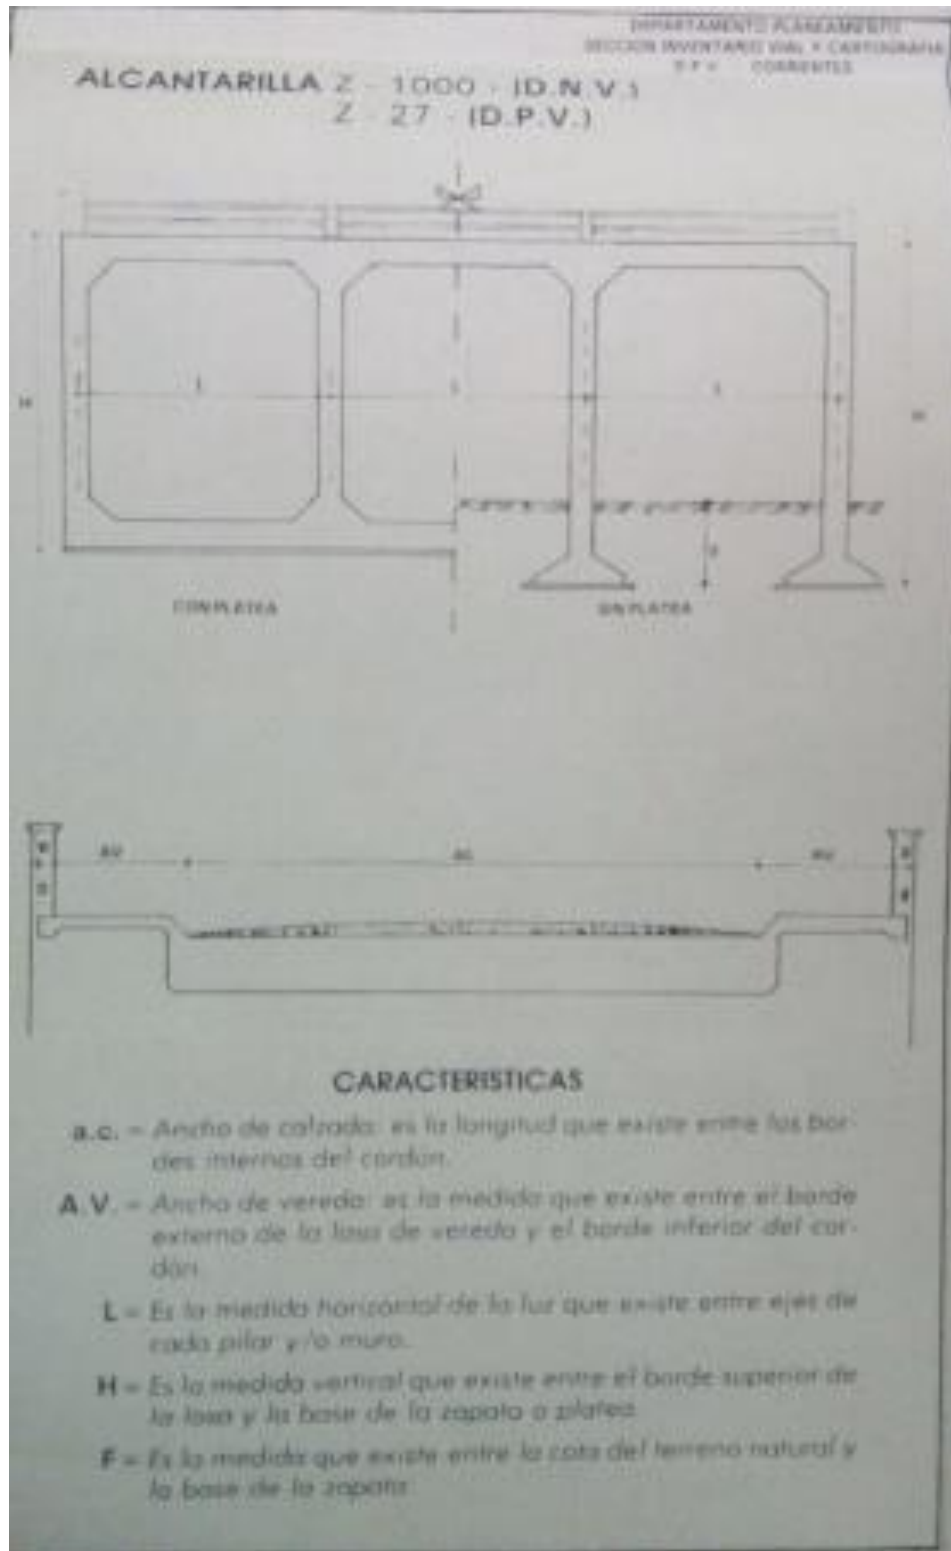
Alcantarilla Tipo – Z (Fuente: Departamento de planeamiento – DPV Corrientes)
